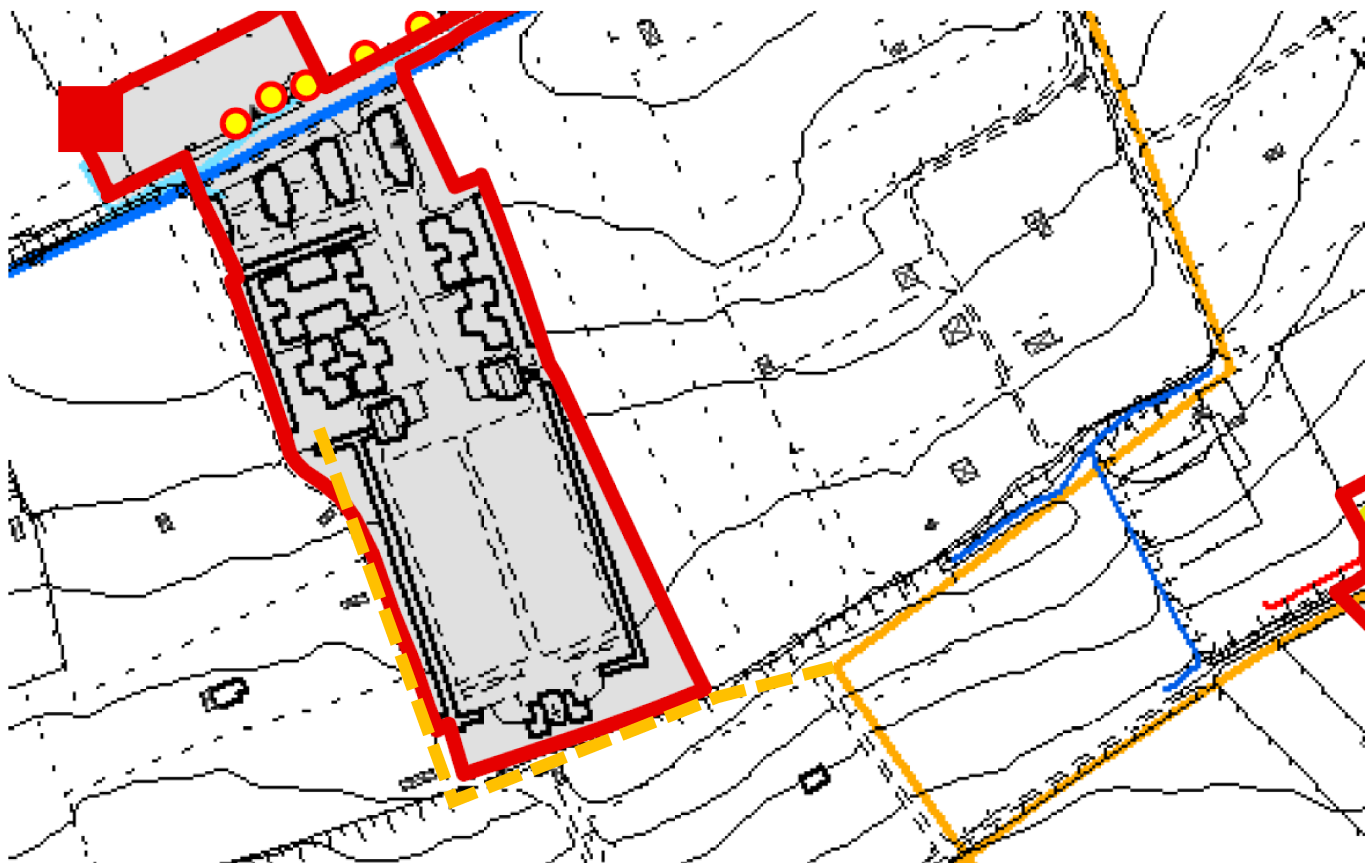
Estratto Reti – urbanizzazione stato di fatto PGT vigente (DdP)
